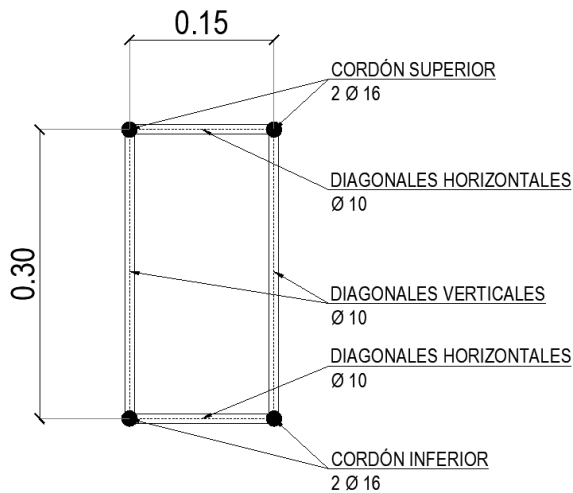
RETICULADO | SECCIÓN TÍPICA
